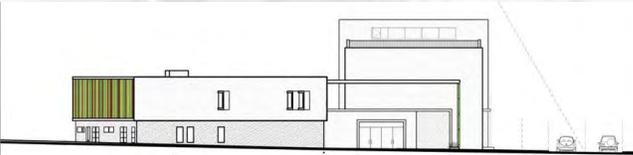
Elevación arquitectónica Centro Cultural Alto hospicio.
